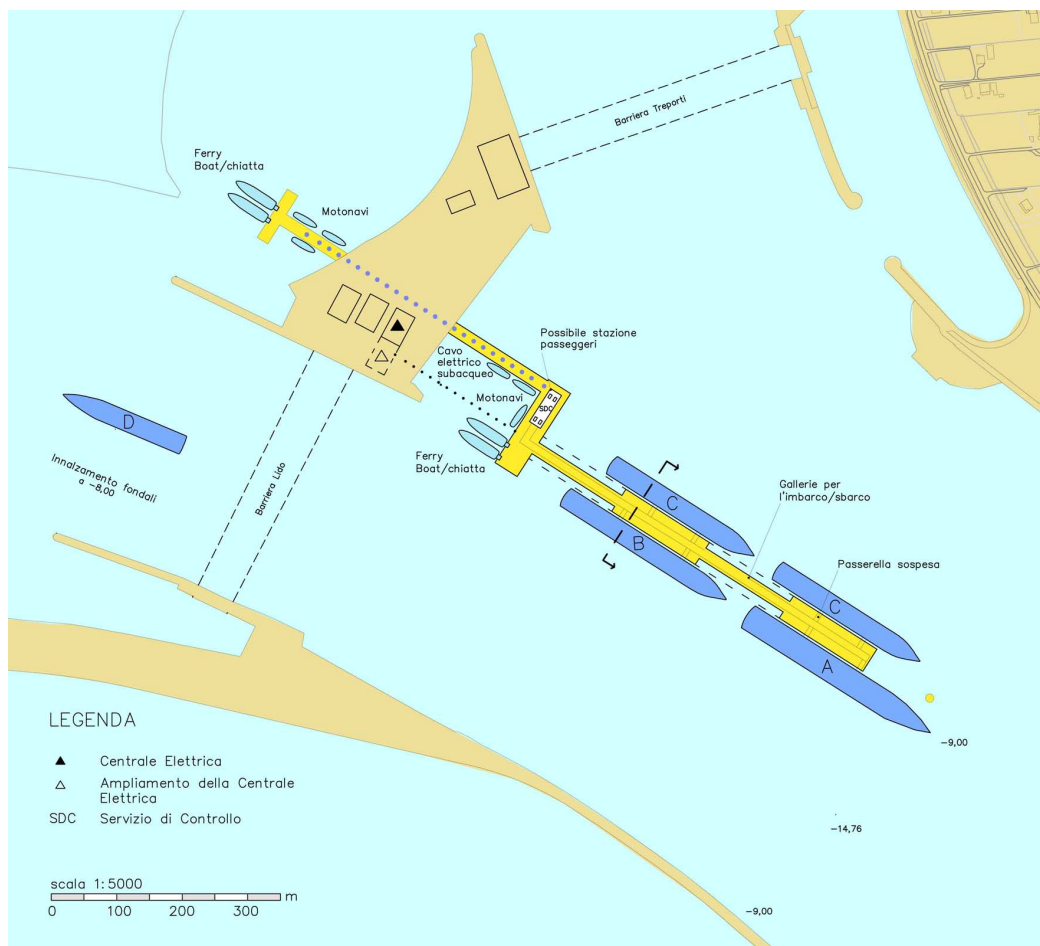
Planimetrias d'insieme con l'inserimento dell'avanporto (ipotesi B).
